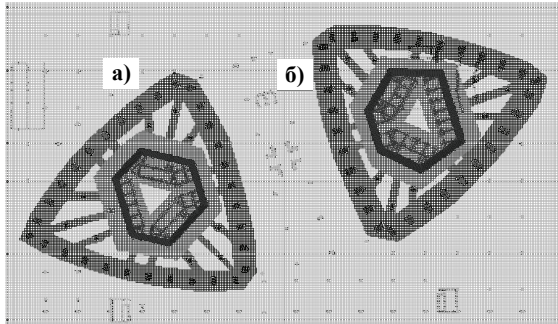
Схема свайних полів под фундаментами плит: (б) - под башней «Б», (в) - под башней «А».
